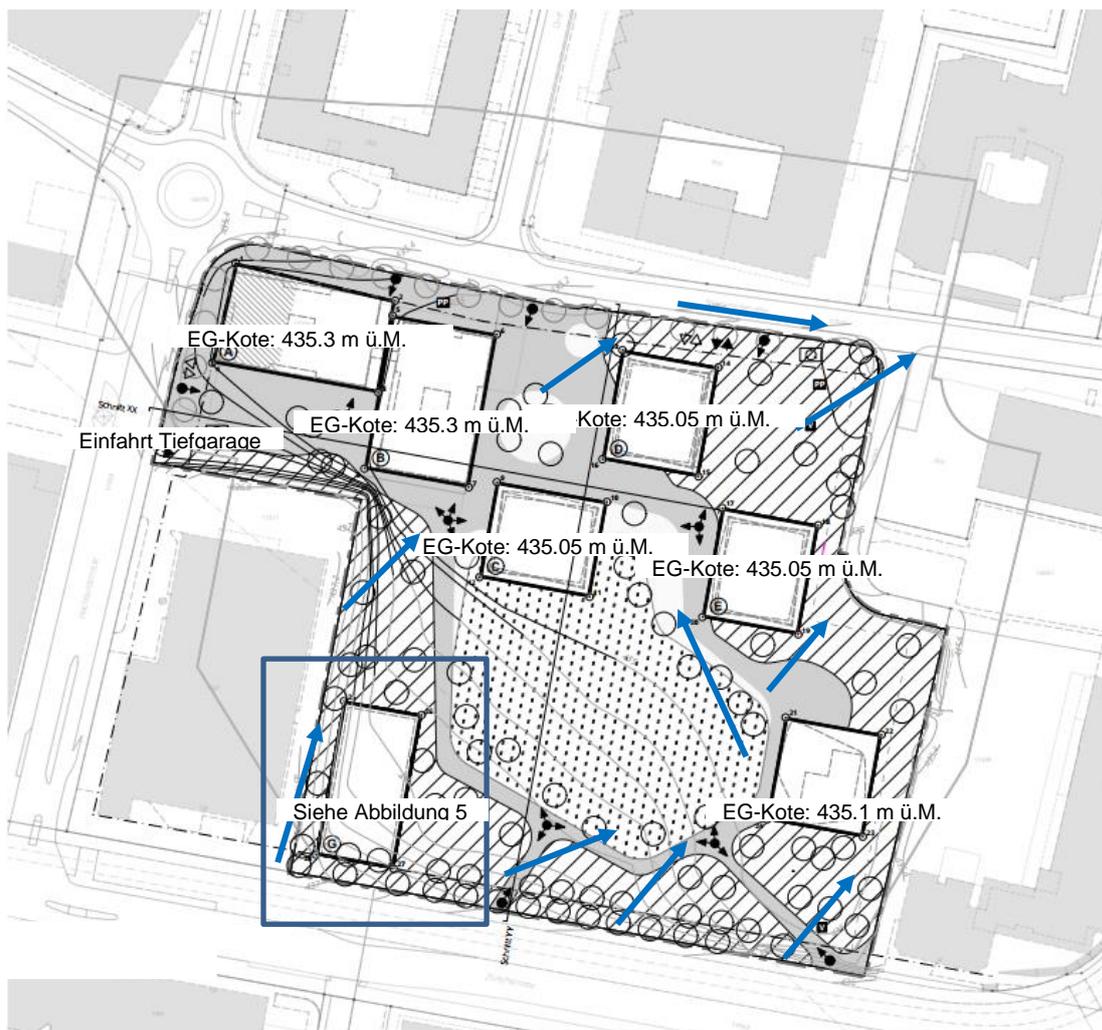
Planausschnitt Gestaltungsplan (Situationsplan vom 28.09.2020) mit Massnahmen und Fliesswege beim Schutzkonzept Gestaltungsplan Hochbord
